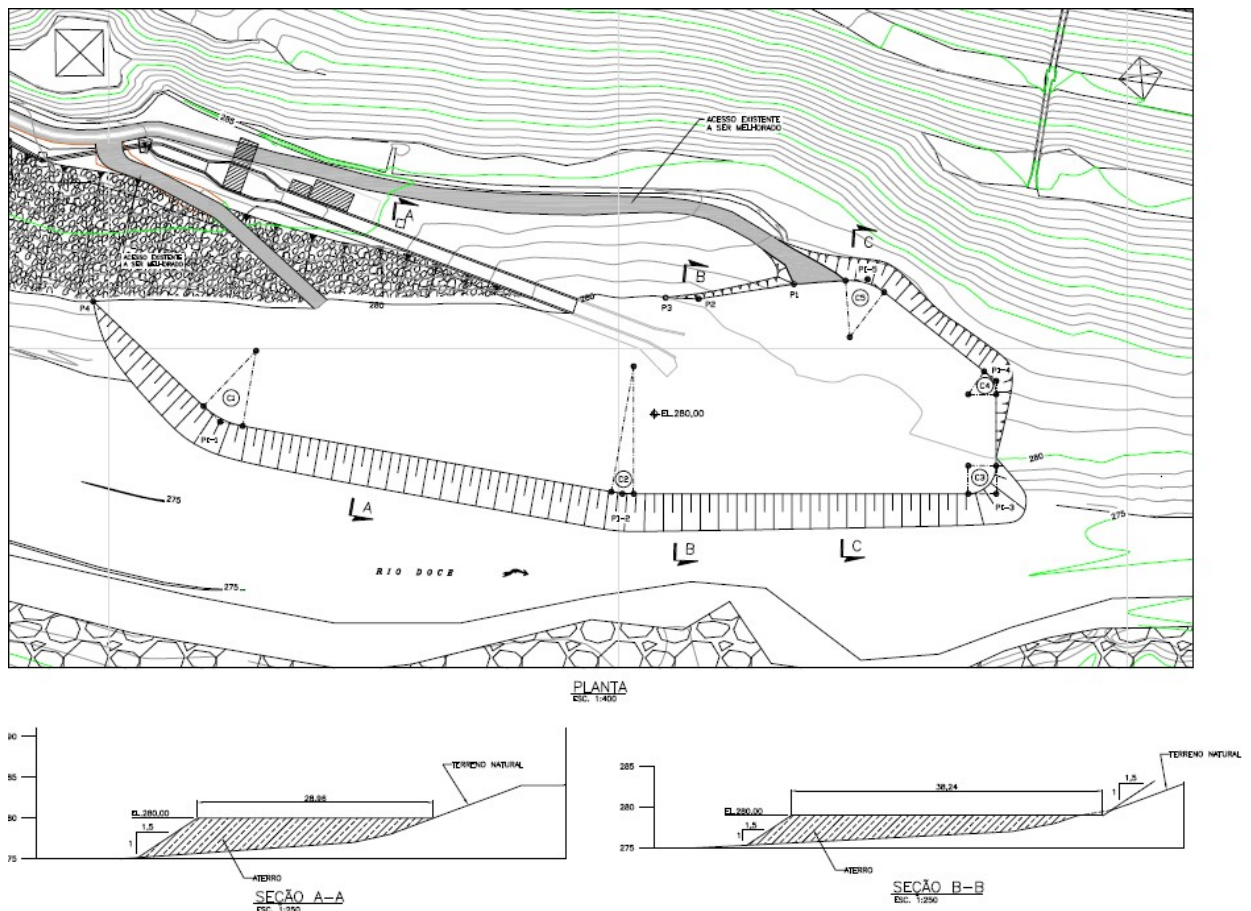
Planta – Dragagem do Canal de Fuga – Praça dos Bag's
